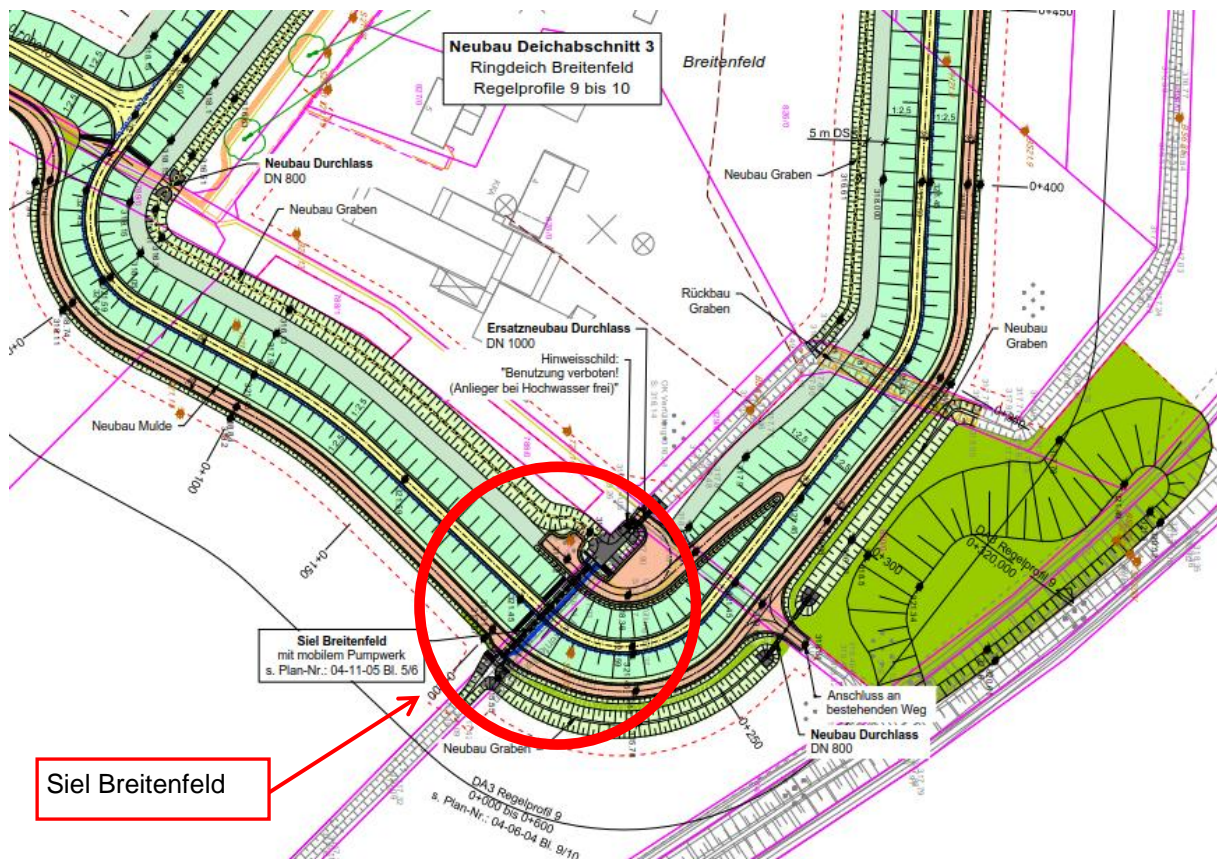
Siel Breitenfeld, Lageplan (aus Plan 03-03-03, Blatt 3/3)
